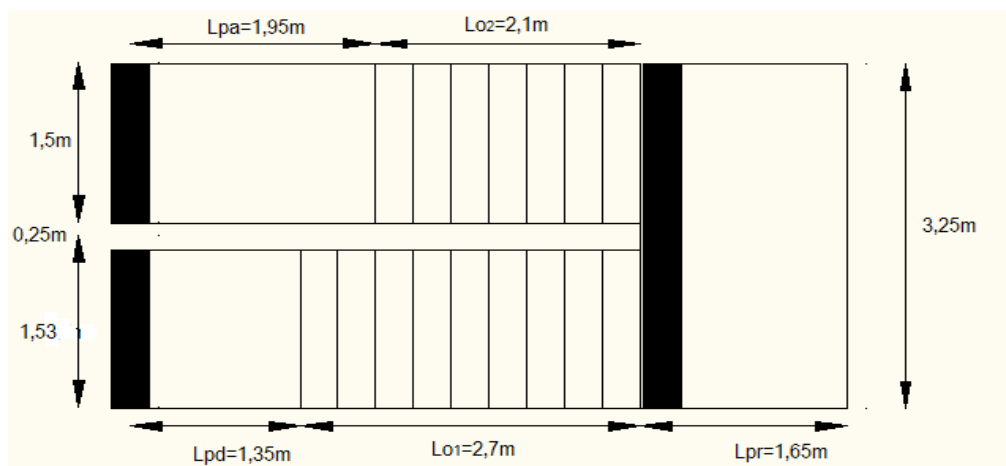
veut en plan d'escalier droit a deux volée.
